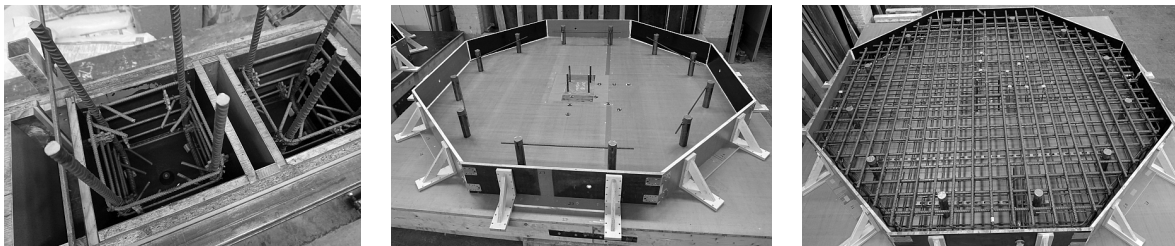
Schalung der Stützenabschnitte (links), des eigentlichen Versuchskörpers mit eingebautem Stützenabschnitt und Hüllrohren (Mitte) sowie mit fertig verlegter Bewehrung (rechts)
